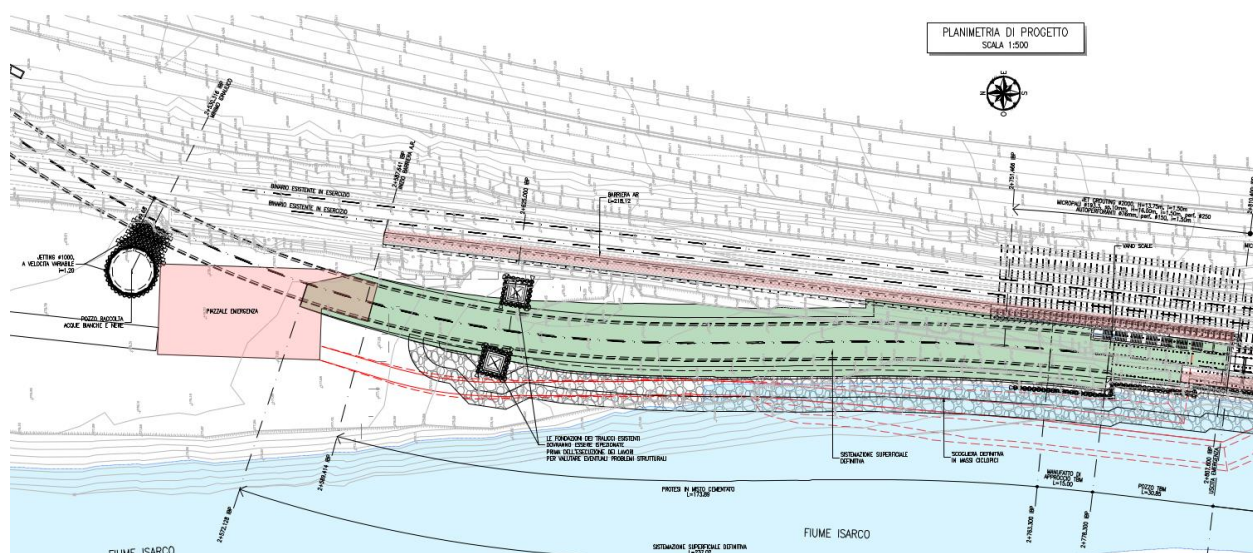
Planimetria dell'imbocco (Parte 2/2)
